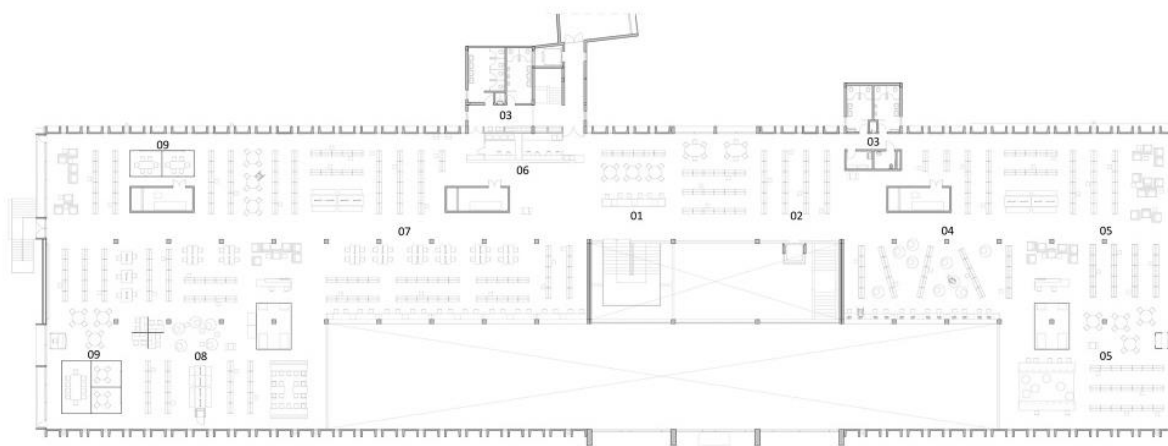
Planta baixa 1 pavimento Biblioteca Estadual Rio de Janeiro. Fonte: Studio Chao (2019).
